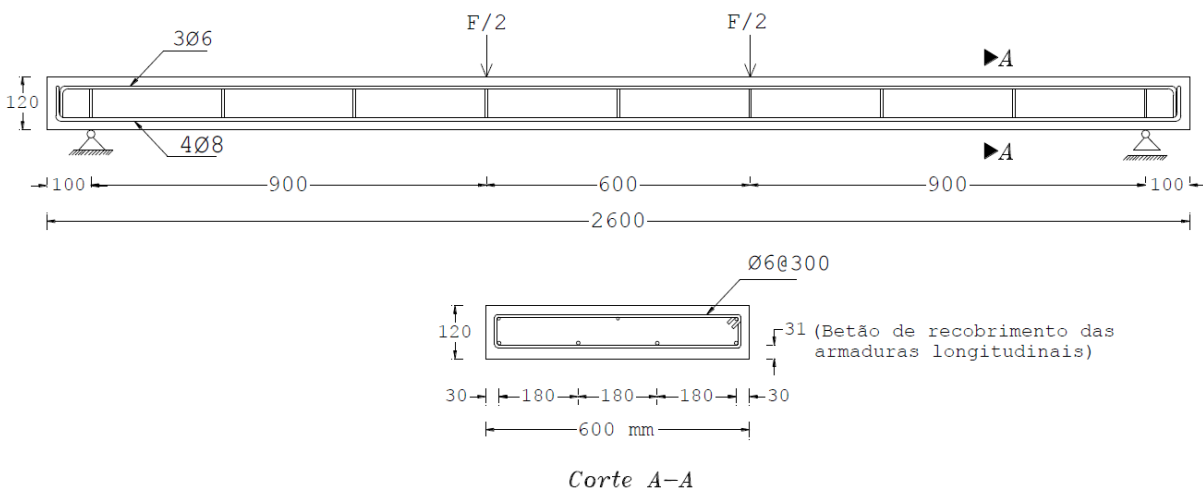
Geometria das lajes ensaiadas (dimensões em mm).
